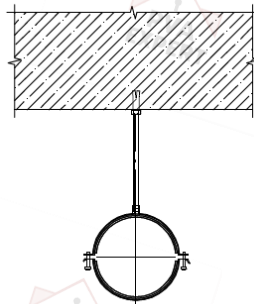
Узел крепления трубы к перекрытию (рядовая опора)
